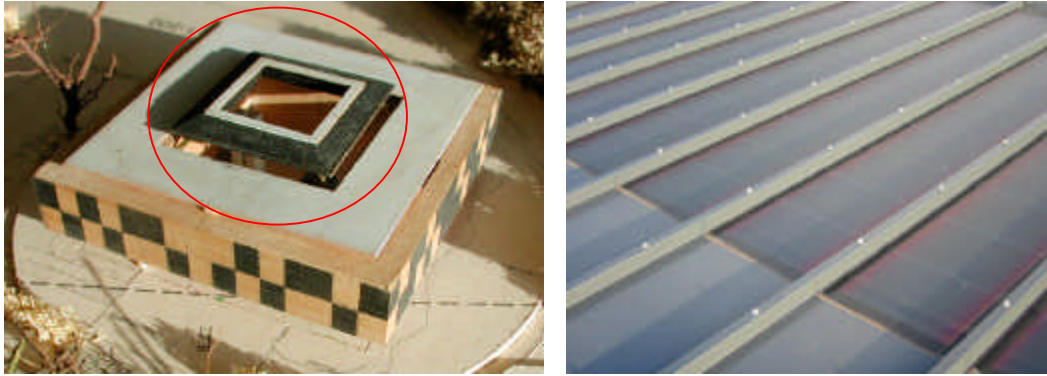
links: Modell des Gebäudes mit Dachkranz Atrium, rechts: Detail der ausgeführten Photovoltaikanlage auf dem Dachkranz.
